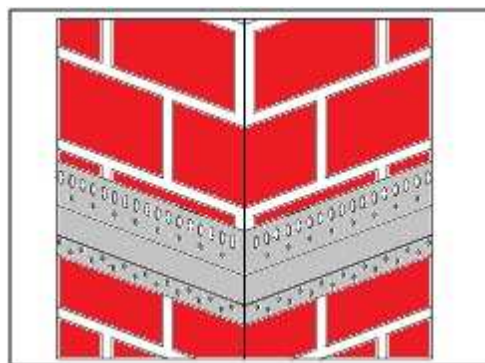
Založení základací lišty (varianta bez zateplení soklu)
